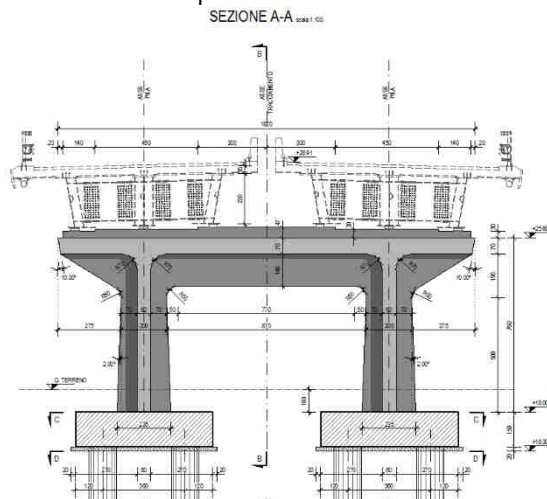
Prospetto pila 6 speciale, tra campate da 48m
